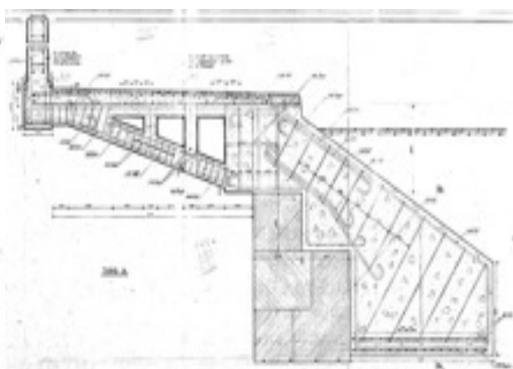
Pormenores de betão armado das consolas e seus prolongamentos estabilizantes interiores (excerto retirado do projeto original) [9]
